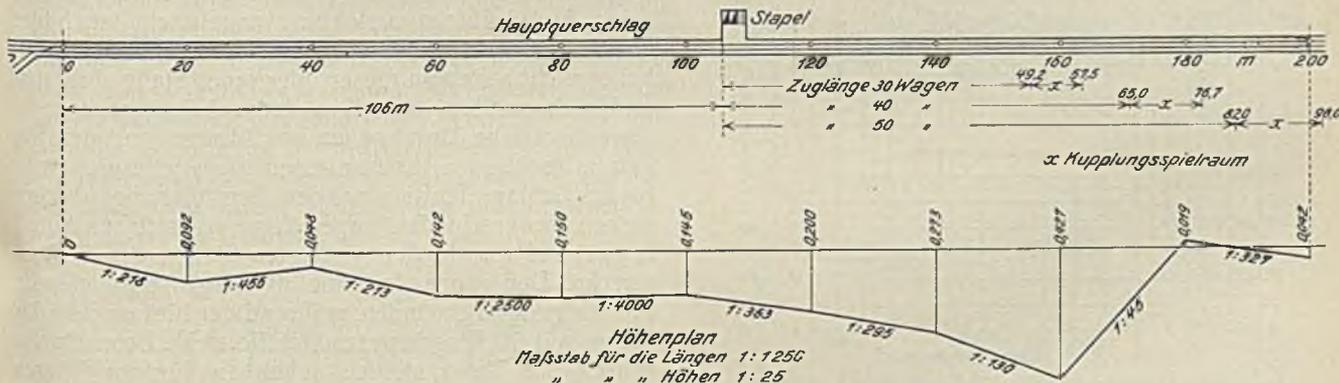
Grundriß und Höhenplan der Versuchsstrecke.
